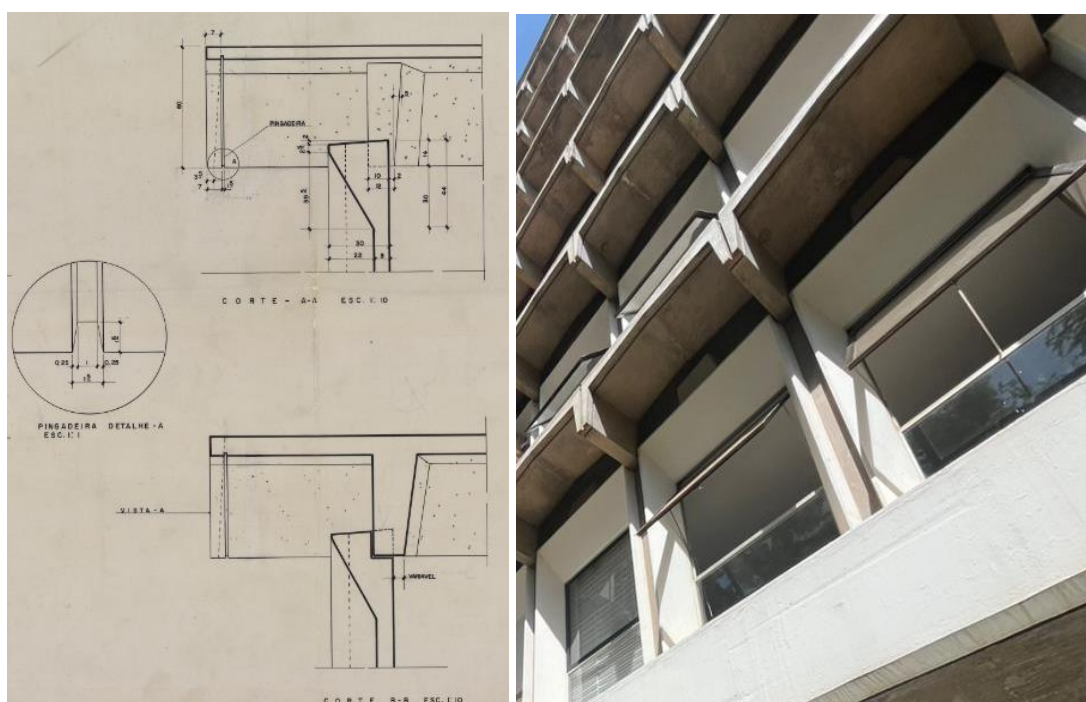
À esquerda: Detalhamento da pingadeira no projeto arquitetônico de Milton Ramos. Fonte: Acervo do Arquiteto Milton Ramos. À direita: foto da pingadeira executada. Fonte: da autora.
